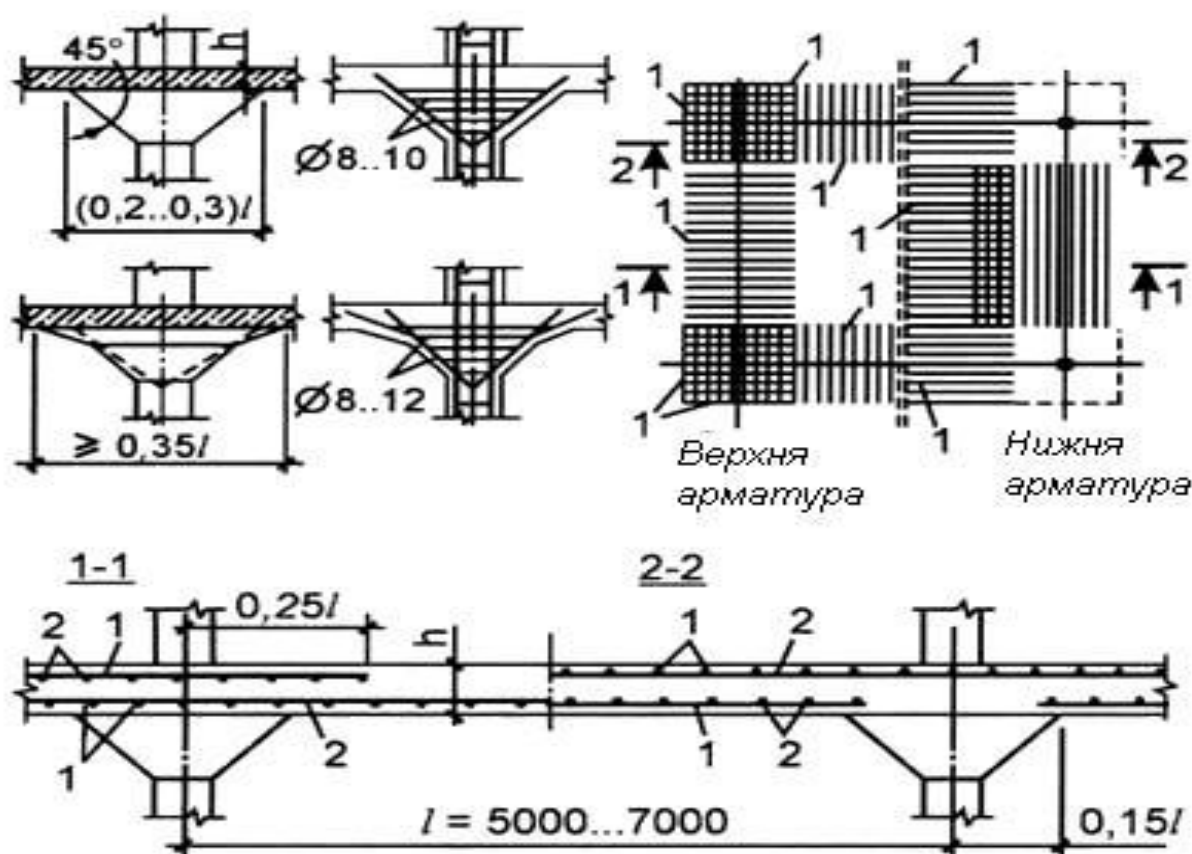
Схема армування плит монолітного безбалкового перекриття
